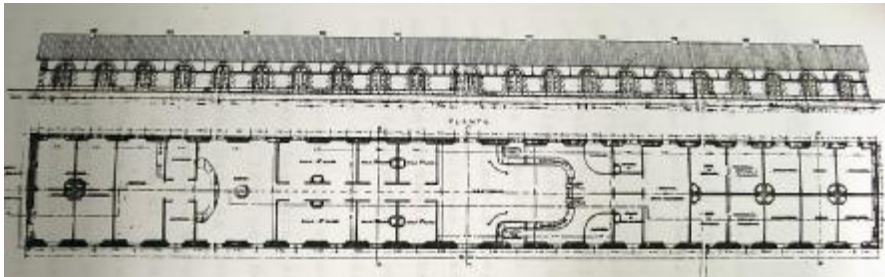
Planta y alzado principal. Edificio de mercancías y viajeros.
